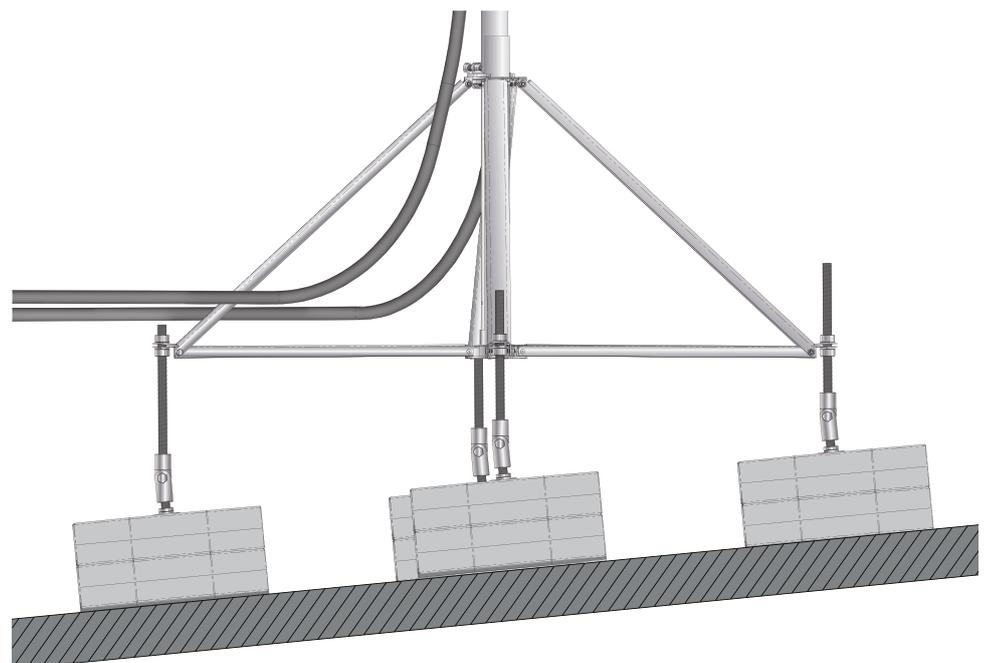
Disposición de bloques de concreto (hormigón) en una ubicación inclinada
